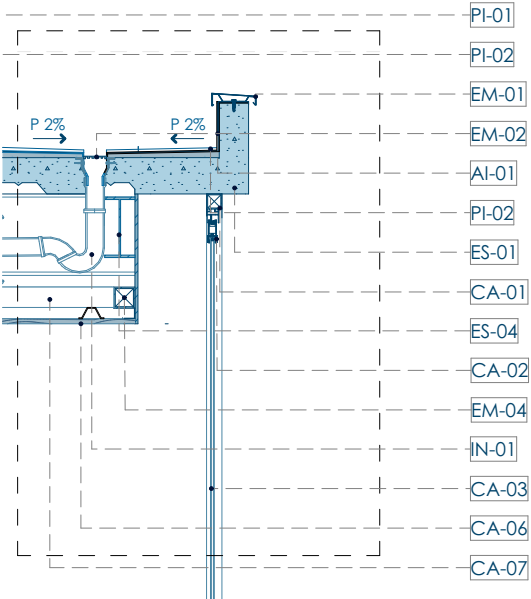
Detalle constructivo 05. Nota. Elaboración propia.
